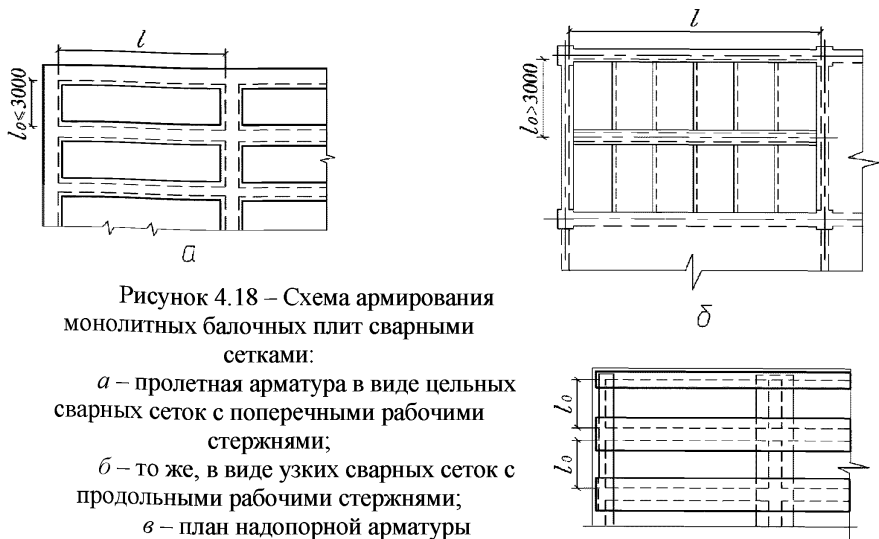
Схема армирования монолитных балочных плит сварными сетками:
